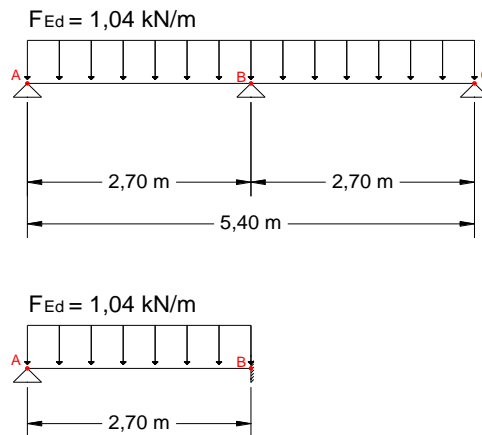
Esquema do modelo adotado para o cálculo do corte nas vigas V1 e V6
